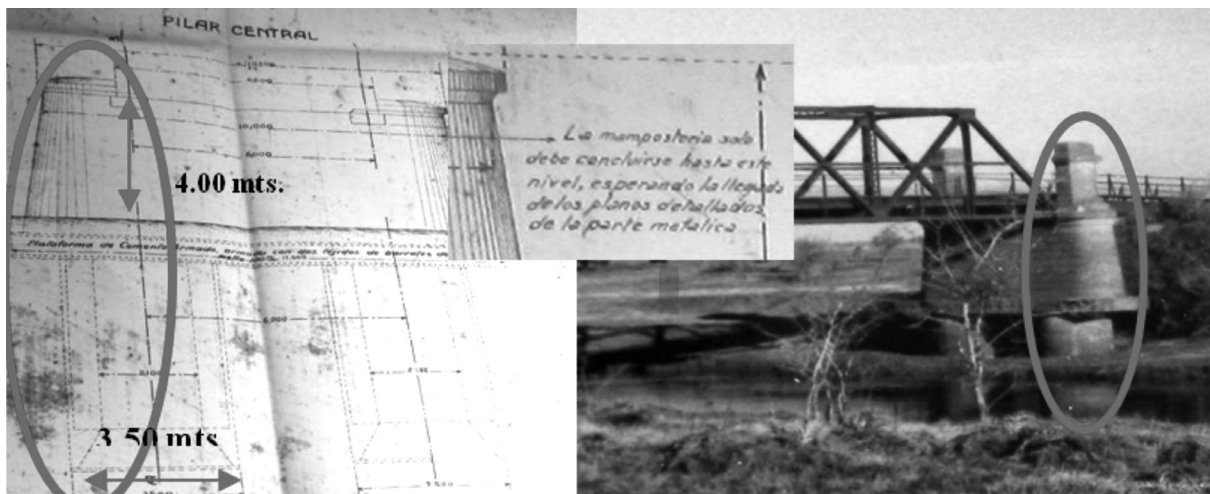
Corte transversal de pilar y las fundaciones. Foto anterior al reemplazo de la estructura.
